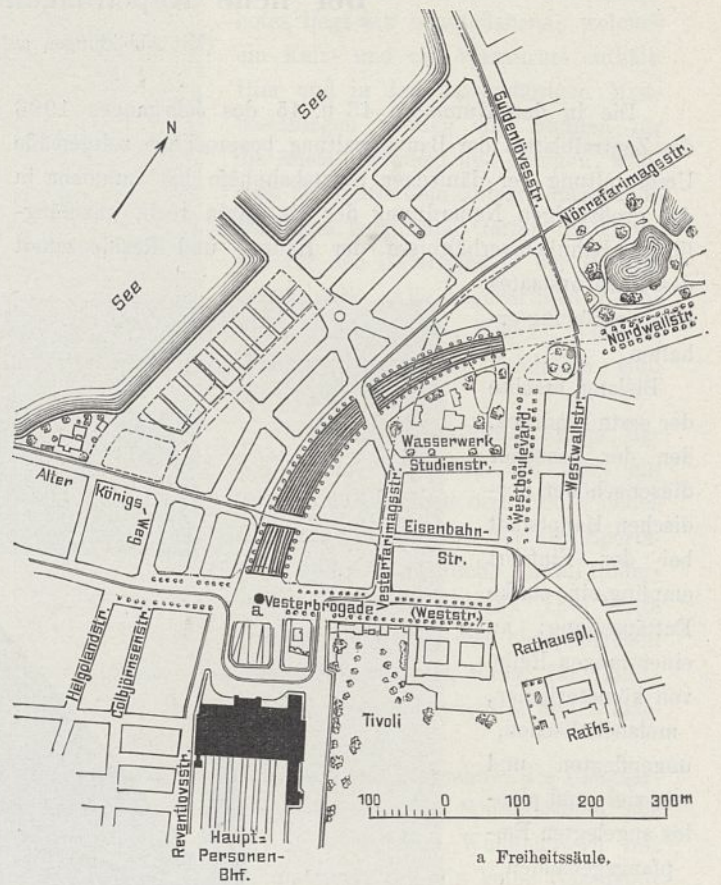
Lageplan des Hauptpersonenbahnhofs.
